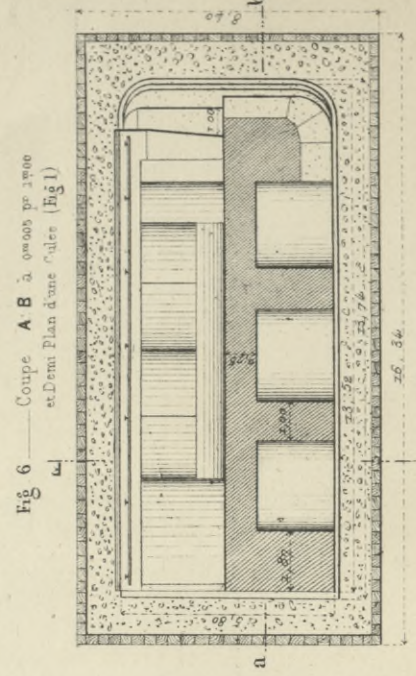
Coupe A B à 0^m005 p^r 1^m00 et Dern Plan d'une Culee (Fig 1)
